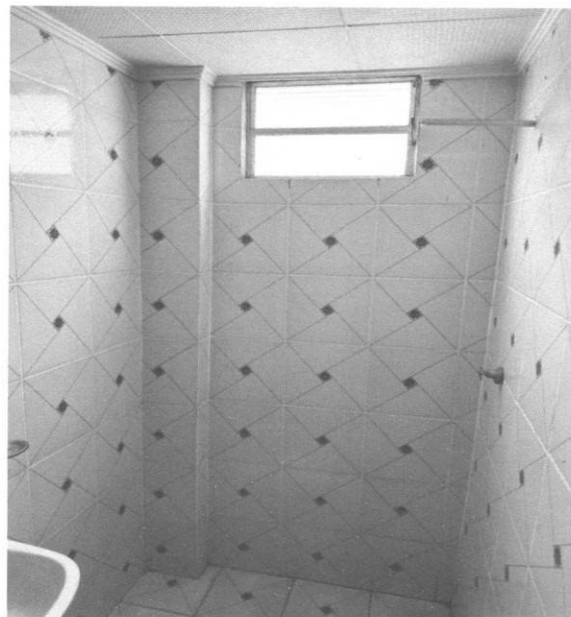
Revestimento cerâmico em bom estado nos banheiros
